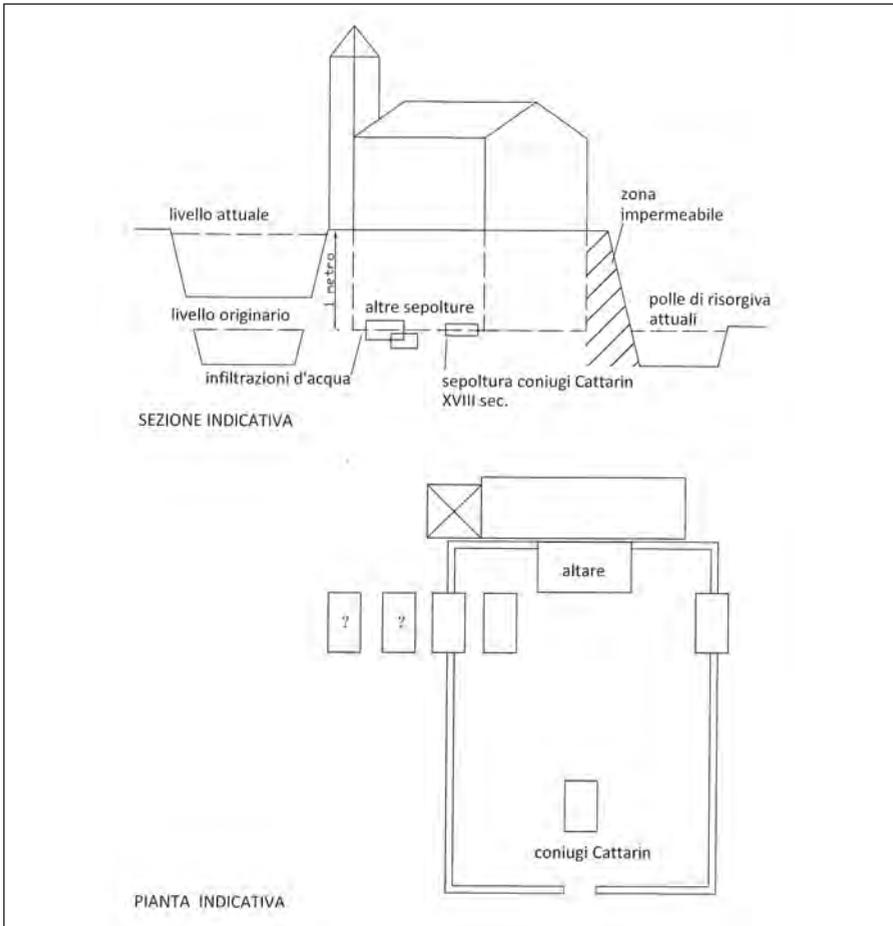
Sezione e pianta dell'edificio denominato *La Madonnetta*.
